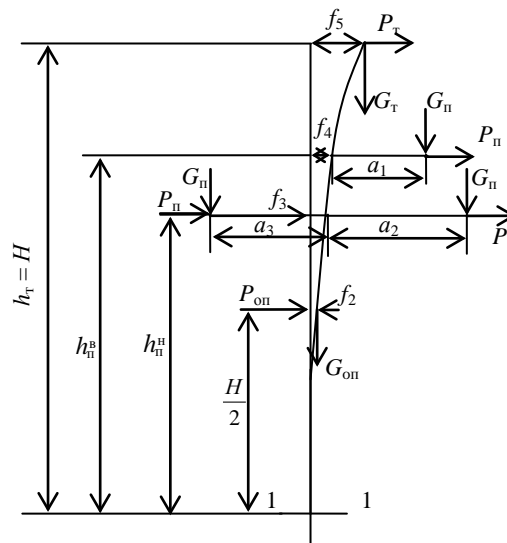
Деформированная схема одностоечной железобетонной опоры: 1–1 – расчетное сечение на уровне земли; a_1, a_2, a_3 – длины траверсы; $P_T, P_n, P_{он}$ – горизонтальные ветровые расчетные нагрузки на грозозащитный трос, провод, опору; $G_T, G_n, G_{он}$ – вертикальные нагрузки от веса троса, провода и опоры
